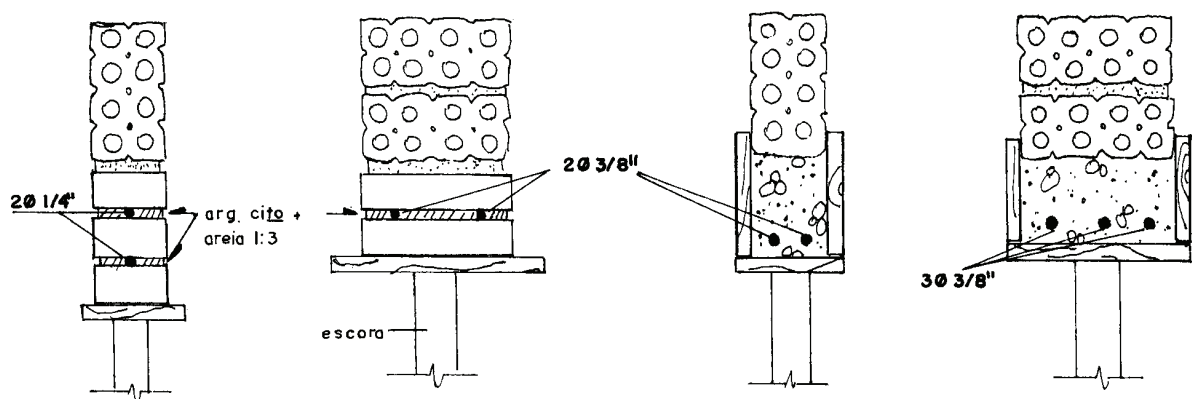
Vergas em alvenaria de tijolo furado para vãos até 1,00m e entre 1,00m e 2,00m
